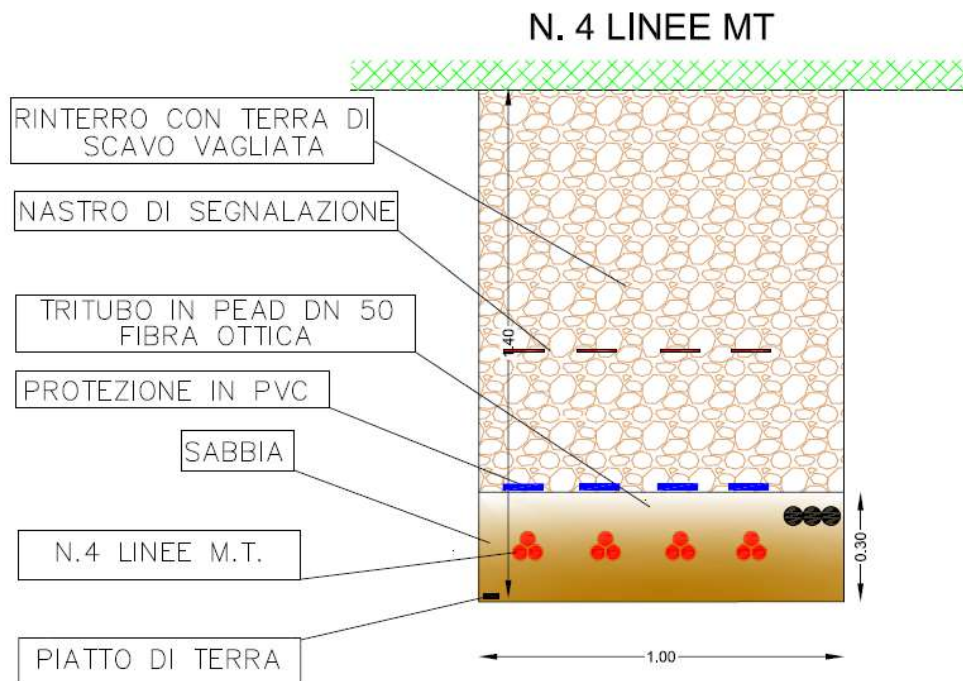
sezione tipo posa cavidotti MT su campo/banchina
